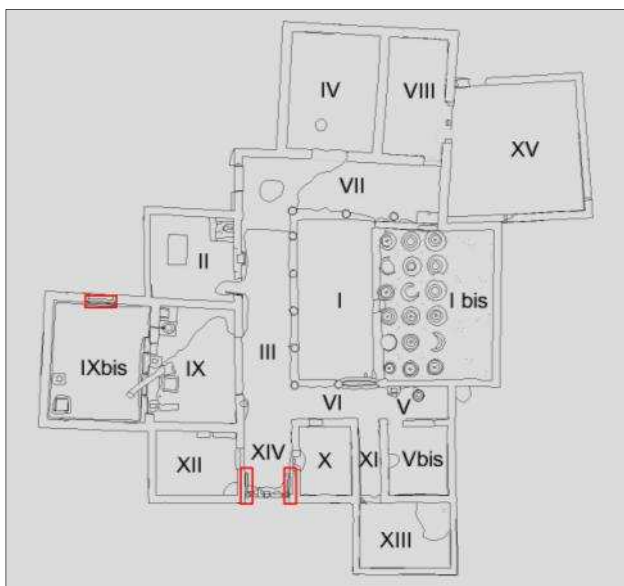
Localizzazione in pianta degli elementi metallici originali.
